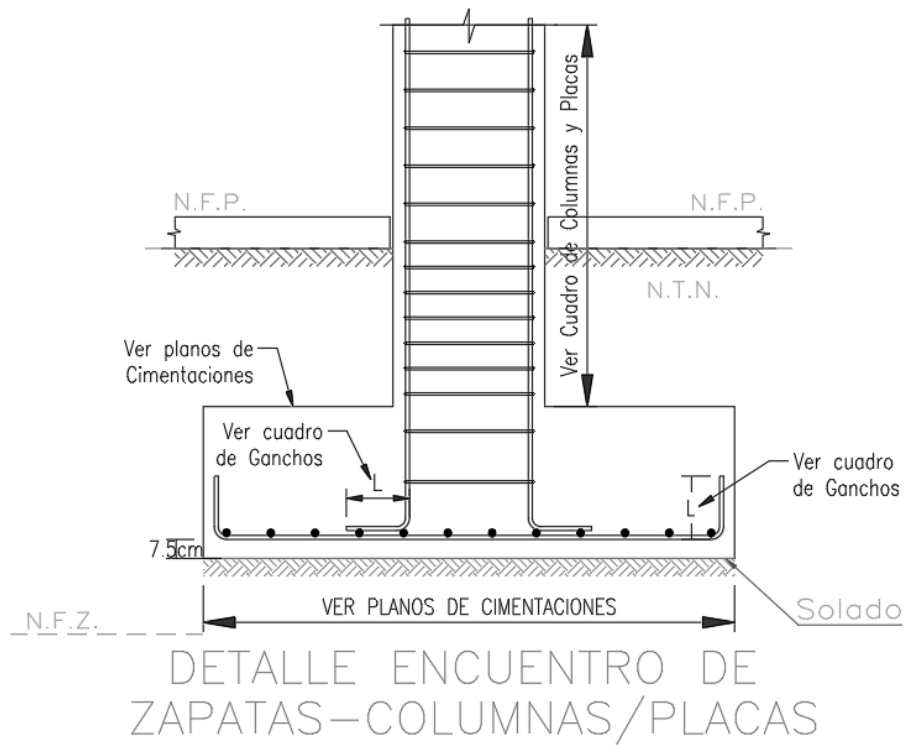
Detalles de zapata con columnas. Fuente: Elaboración Propia.
